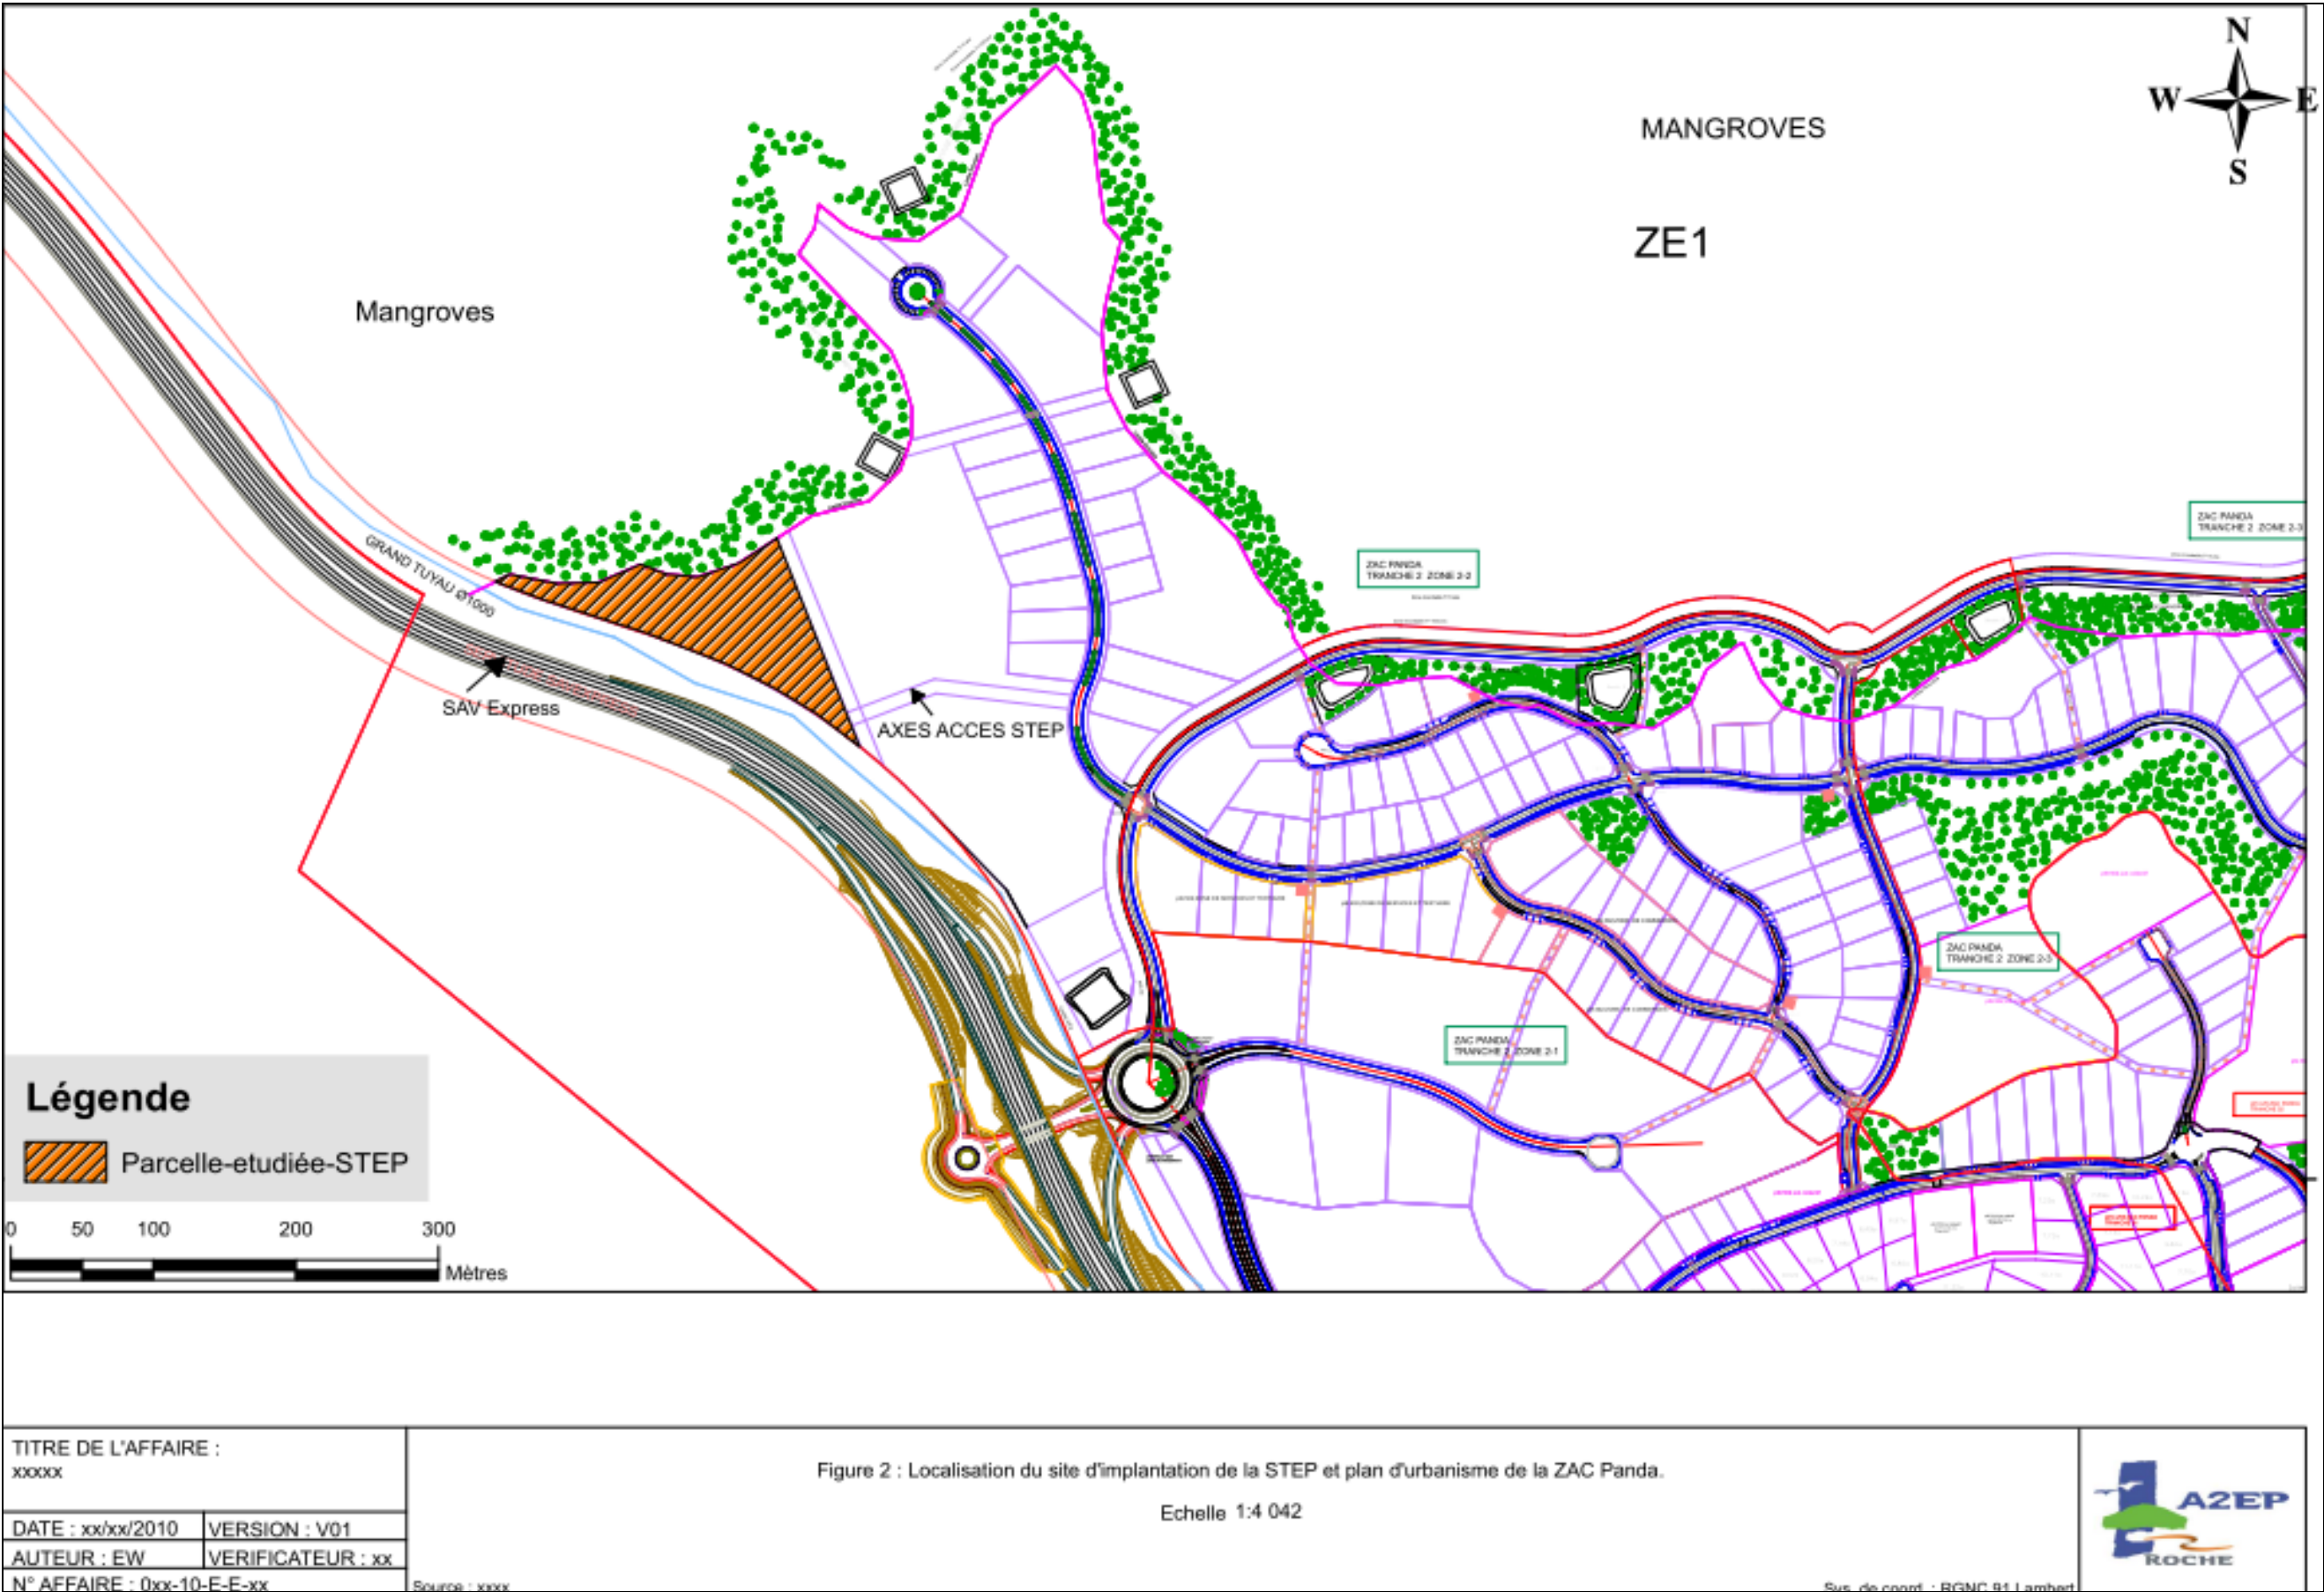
Localisation du site d'implantation de la STEP et plan d'aménagement de la ZAC Panda.
